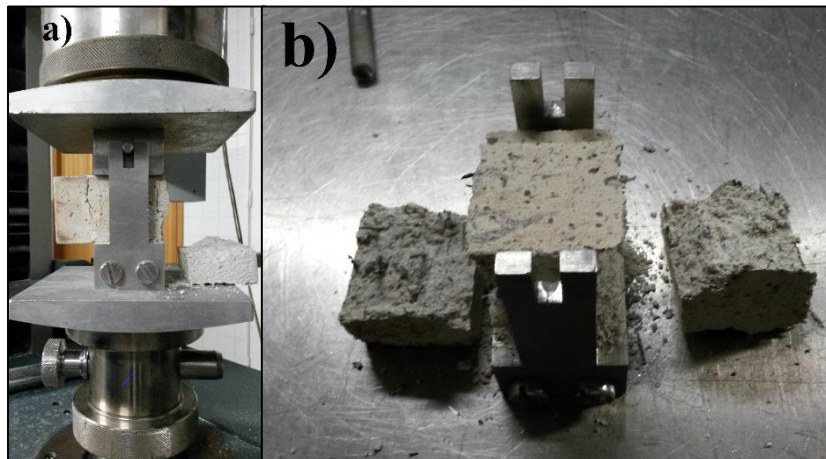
Ensaio e rotura à compressão de um provete prismático da argamassa
